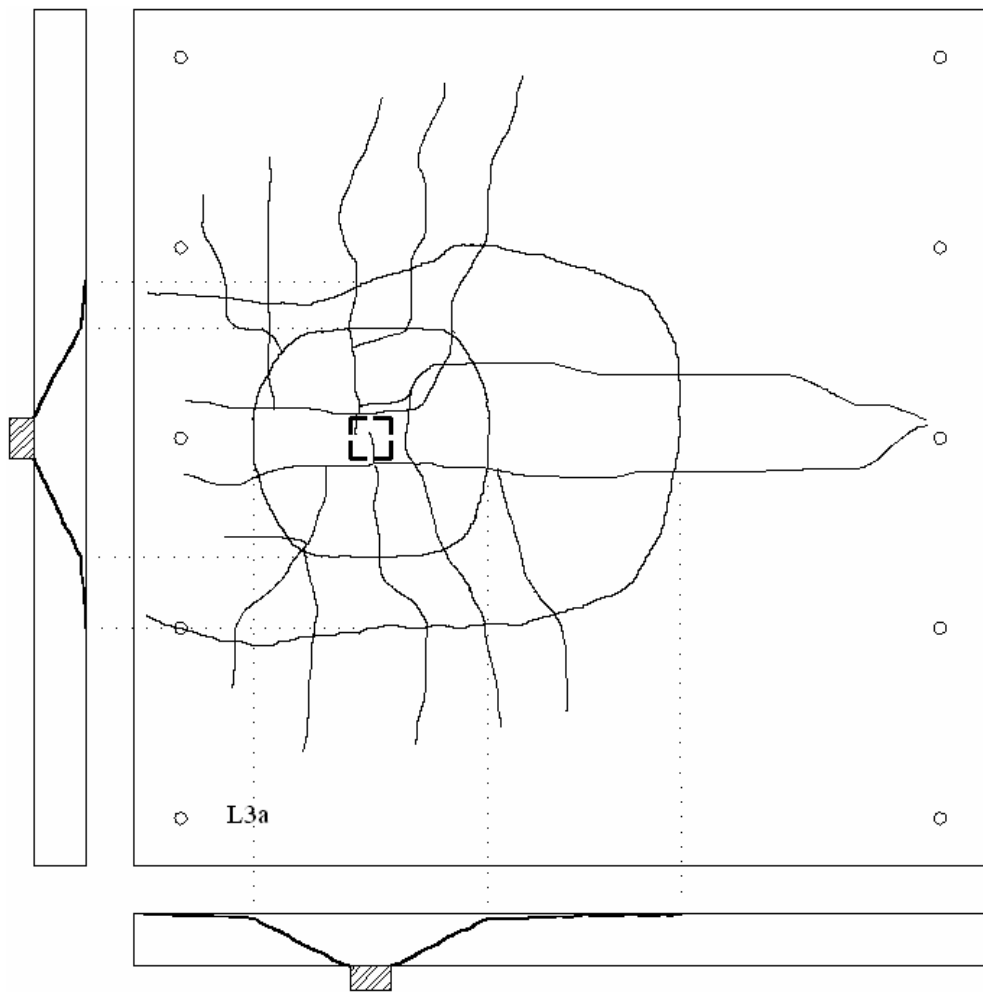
Mapa de fissuração da laje L3a
